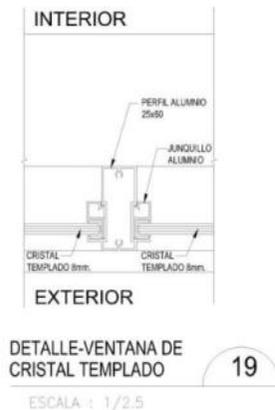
Detalle de instalación de ventana- detalle de vista en planta
